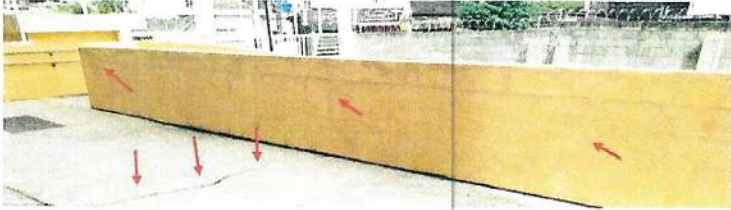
VISTA DO ACESSO À RAMPRA FISSURAS E TRINCAS NA ALVENARIA E MOVIMENTAÇÃO NO PISO
